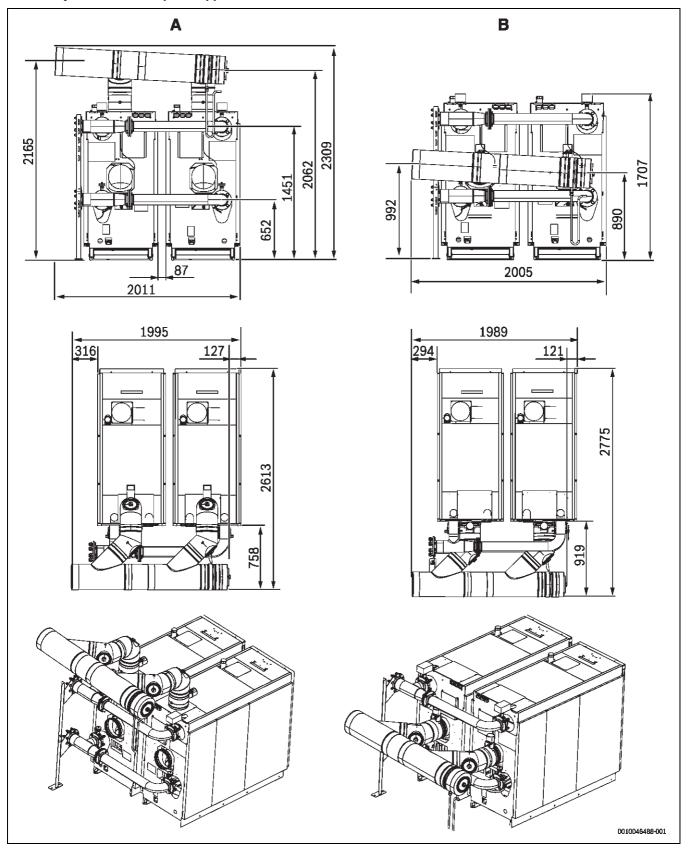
Abmessungen Condens 7000 FP 2  $\times$  350 ... 2  $\times$  500 kW – 2-Kessel-Kaskade mit motorgesteuerter hydraulischer Absperrklappe (Maße in mm); (Technische Daten  $\rightarrow$  Tab. 15, Seite 66)
